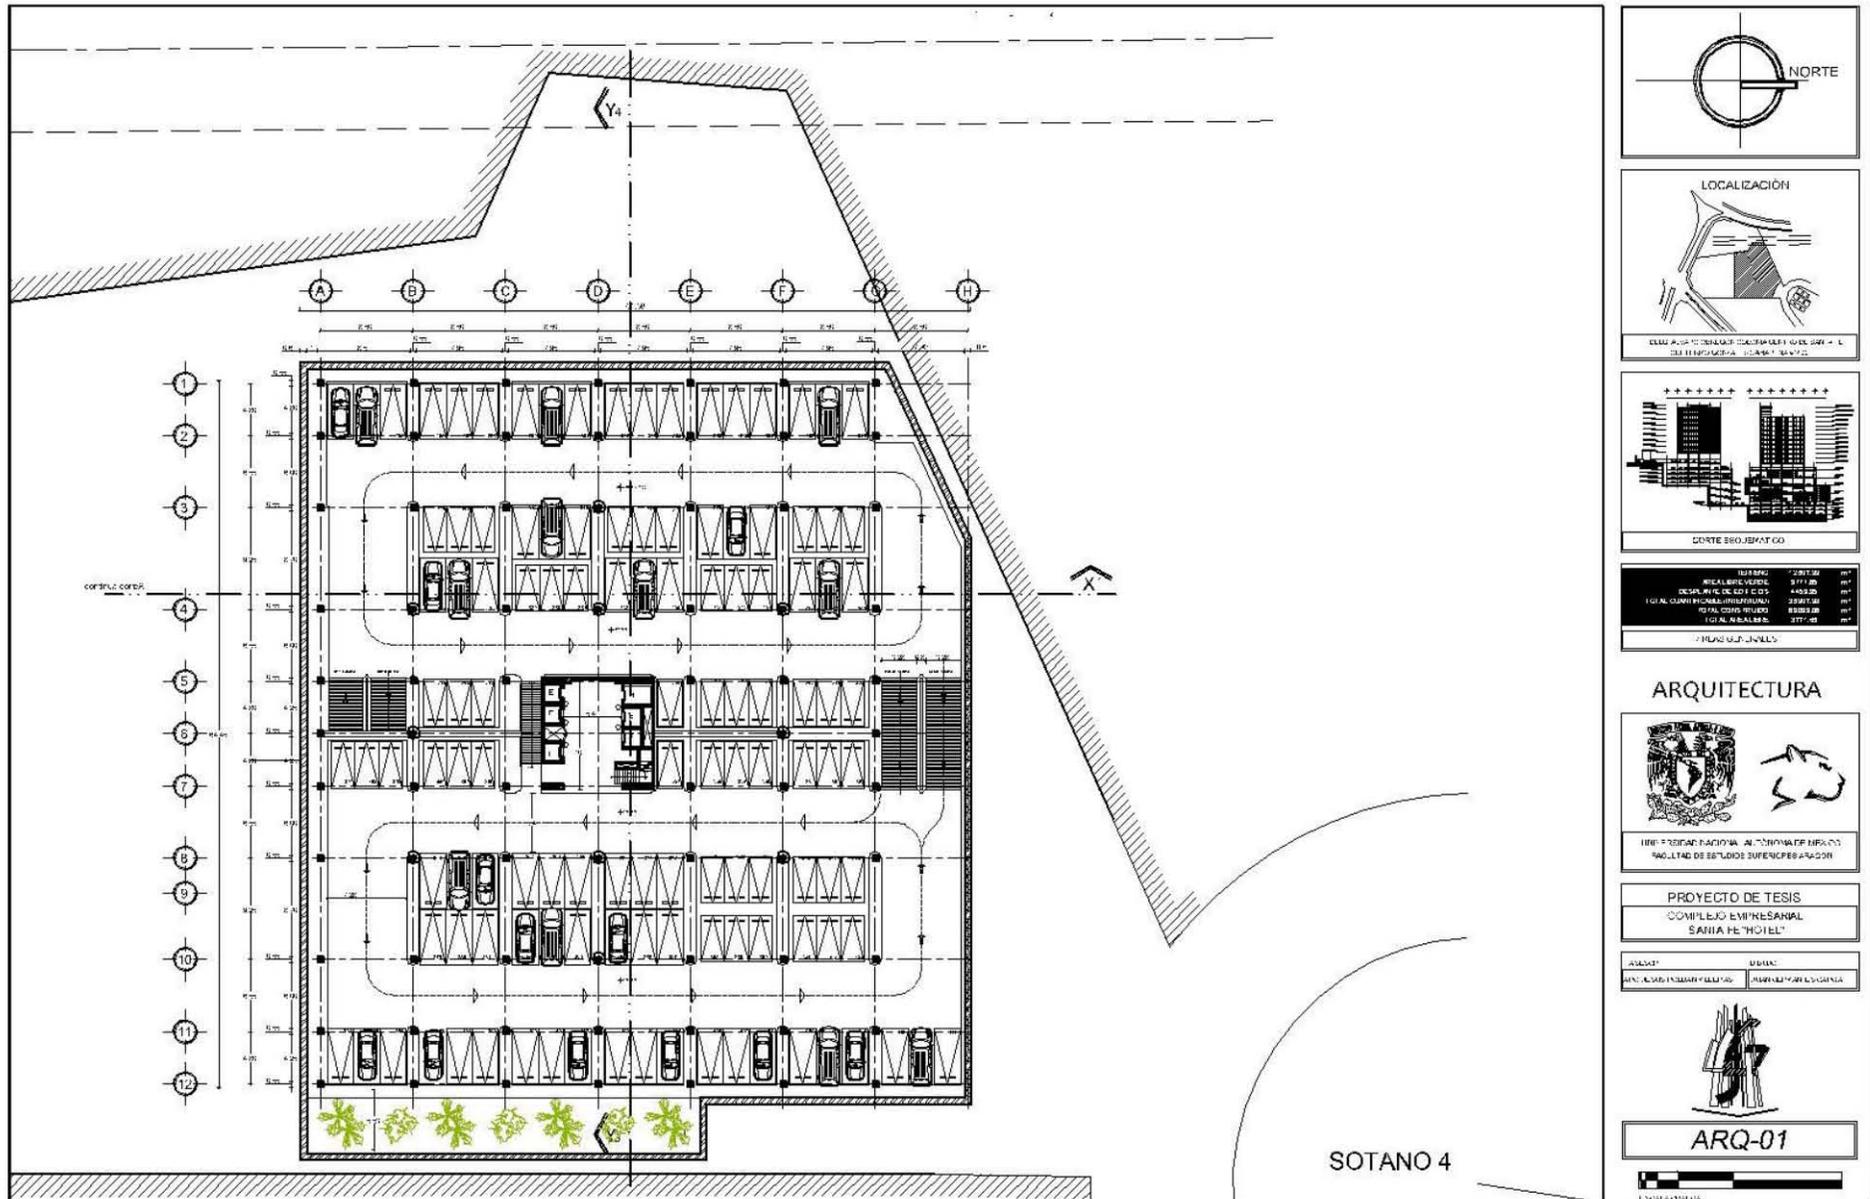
Plano ARQ-01; Sótano 4 Hotel/Centro Comercial. Edición propia.
